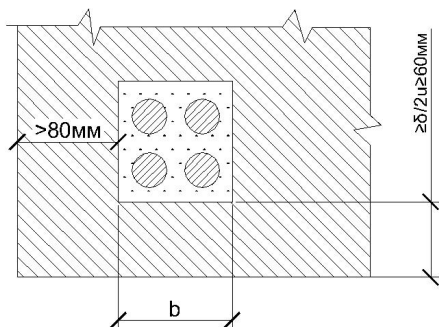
Товщина захисного шару бетону до поверхні каналу, призначеного для кругового розташування арматури.
